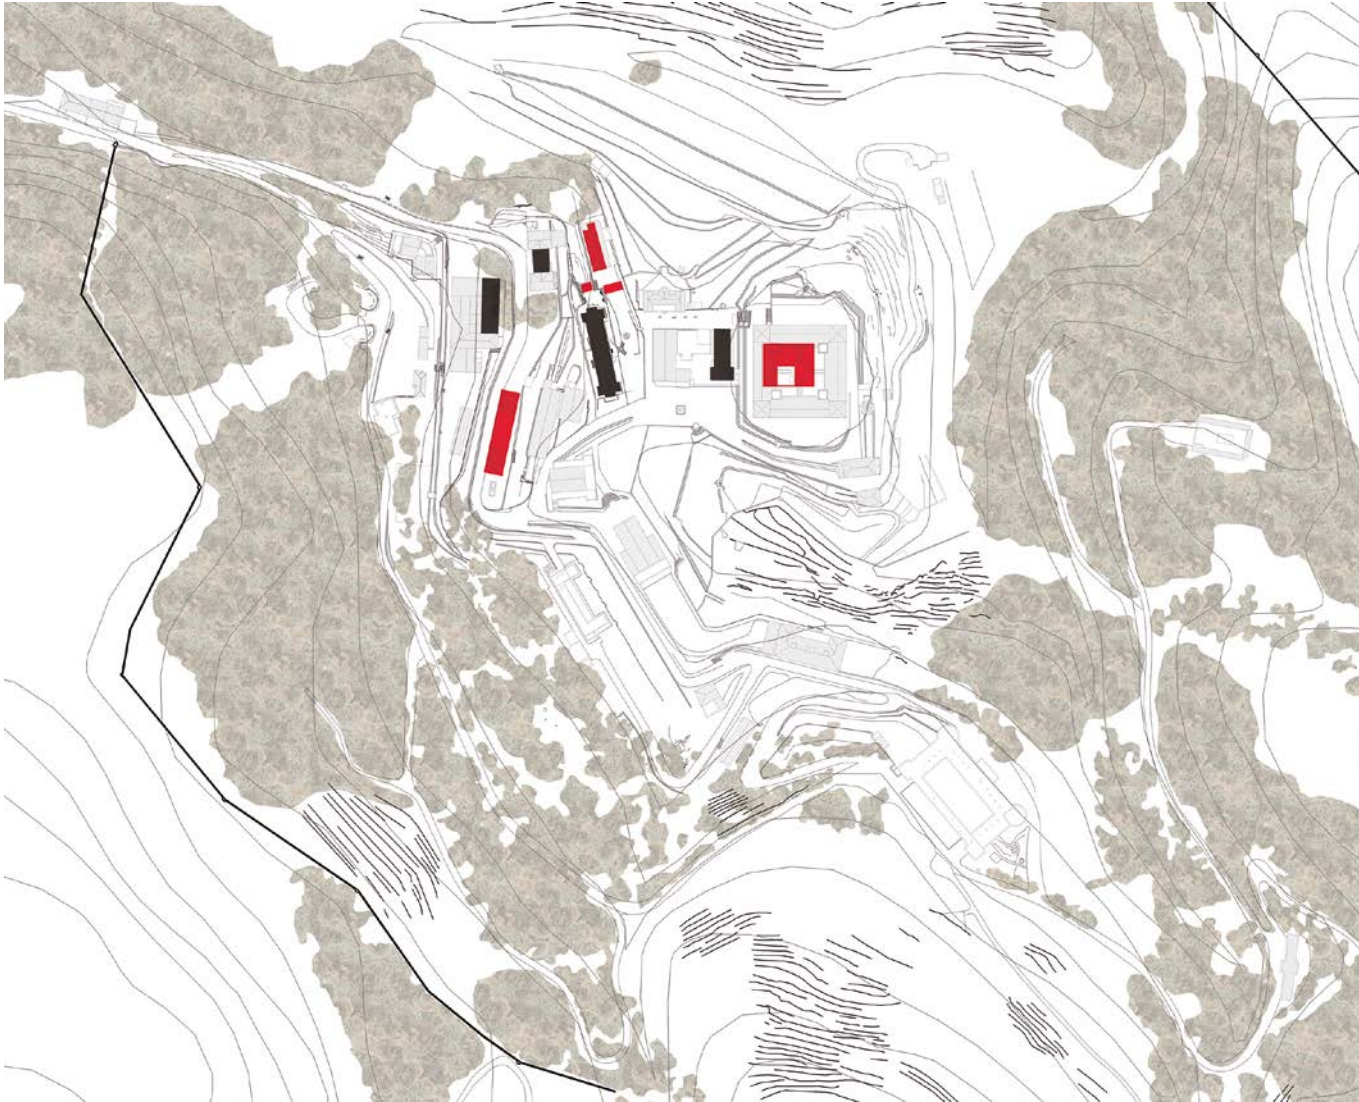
La materialización del Fontilles Pabellonario. (1908-1911). Pabellón de San Rafael, Costurero-Lavadero, Pabellón de Santa Isabel, Pabellón de San Lázaro, Viviendas para leprosos.
